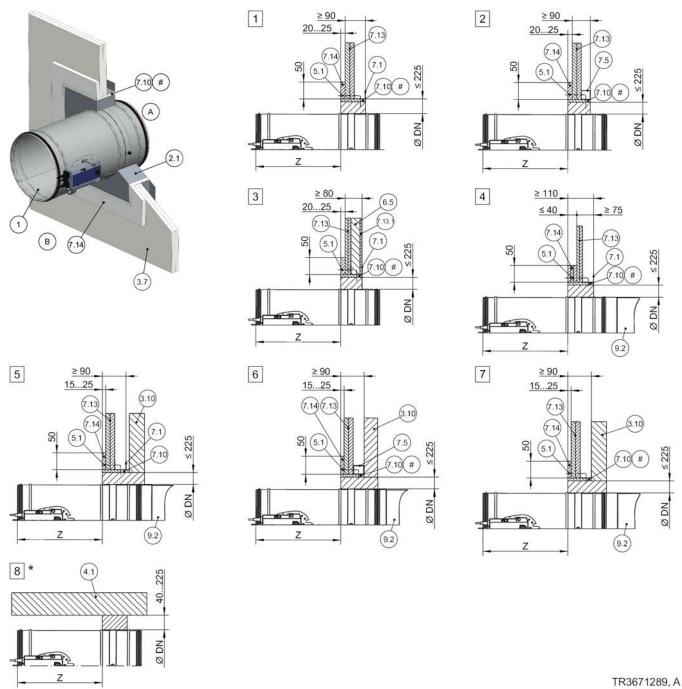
Montagem molhada numa parede de caixa com estrutura de apoio de metal
